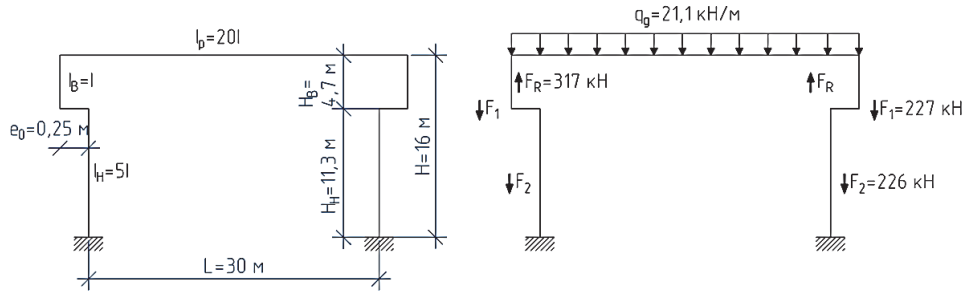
Расчетная схема однопролетной поперечной рамы промышленного здания
